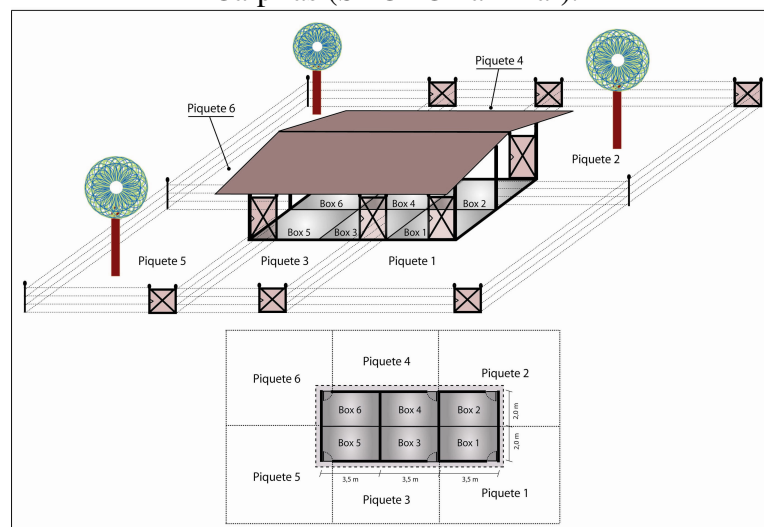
Layout do Modelo de Multiplicação de Galinhas Caipiras (SACAC Industrial)
